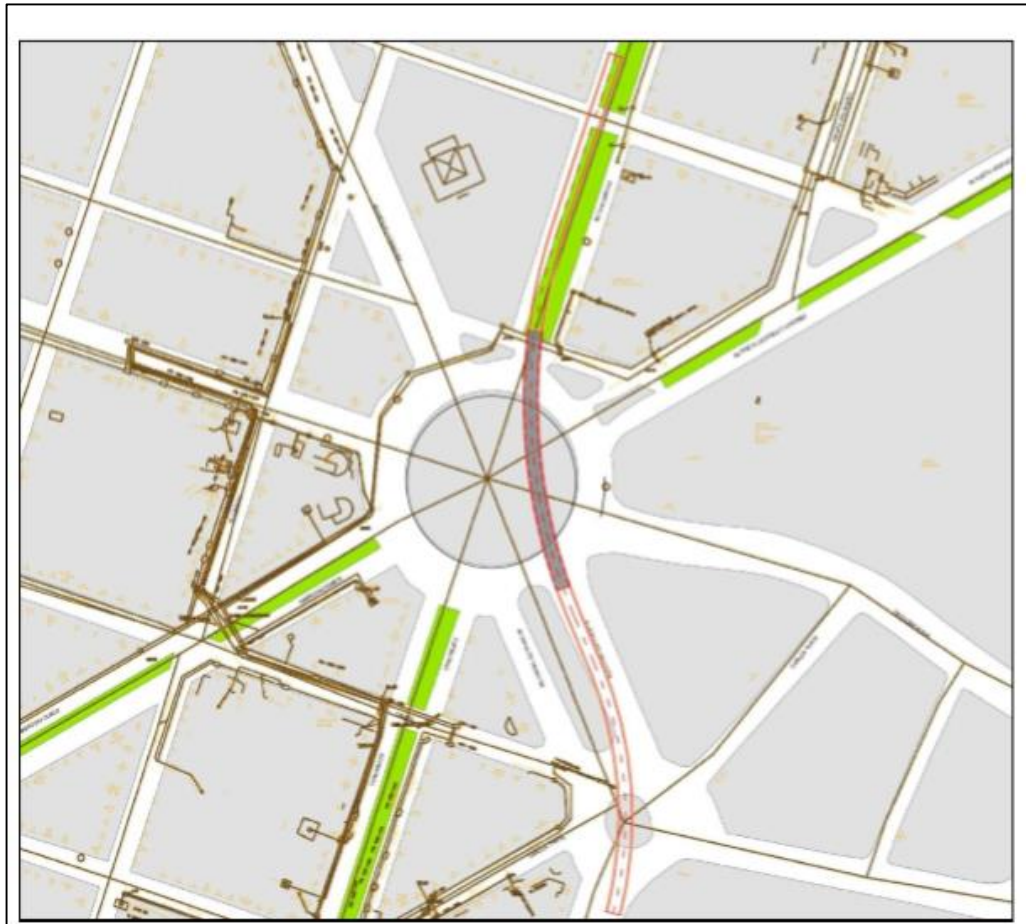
Planimetría con líneas existentes de la red de telefónica.
